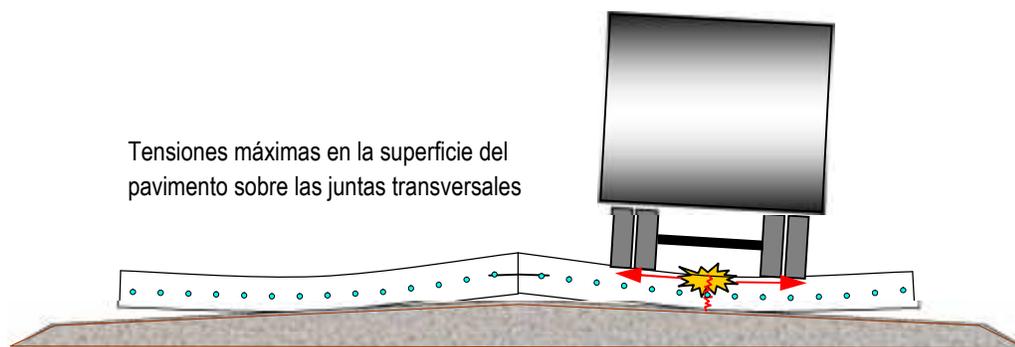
Fisuras tempranas en pavimentos rígidos
